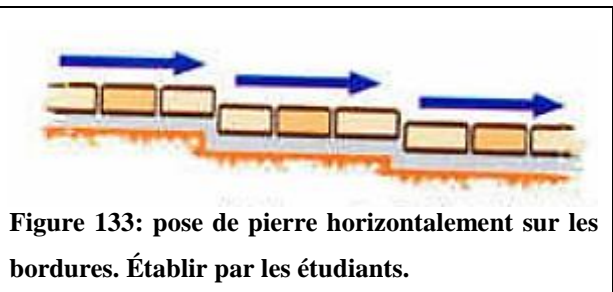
pose de pierre horizontalement sur les bordures. Établir par les étudiants.
